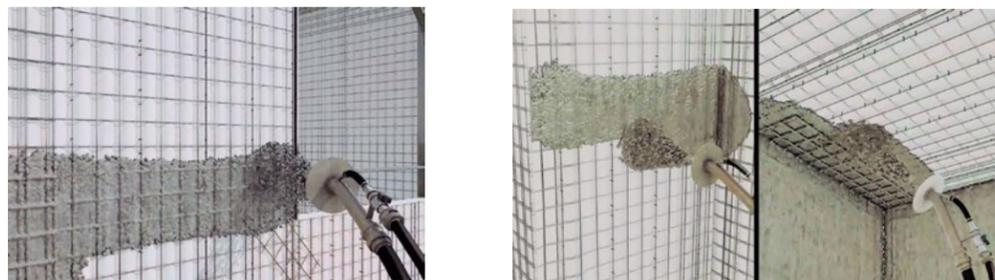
Ilustración típica unión losas y muros estructurales de paneles EMMEDUE.
